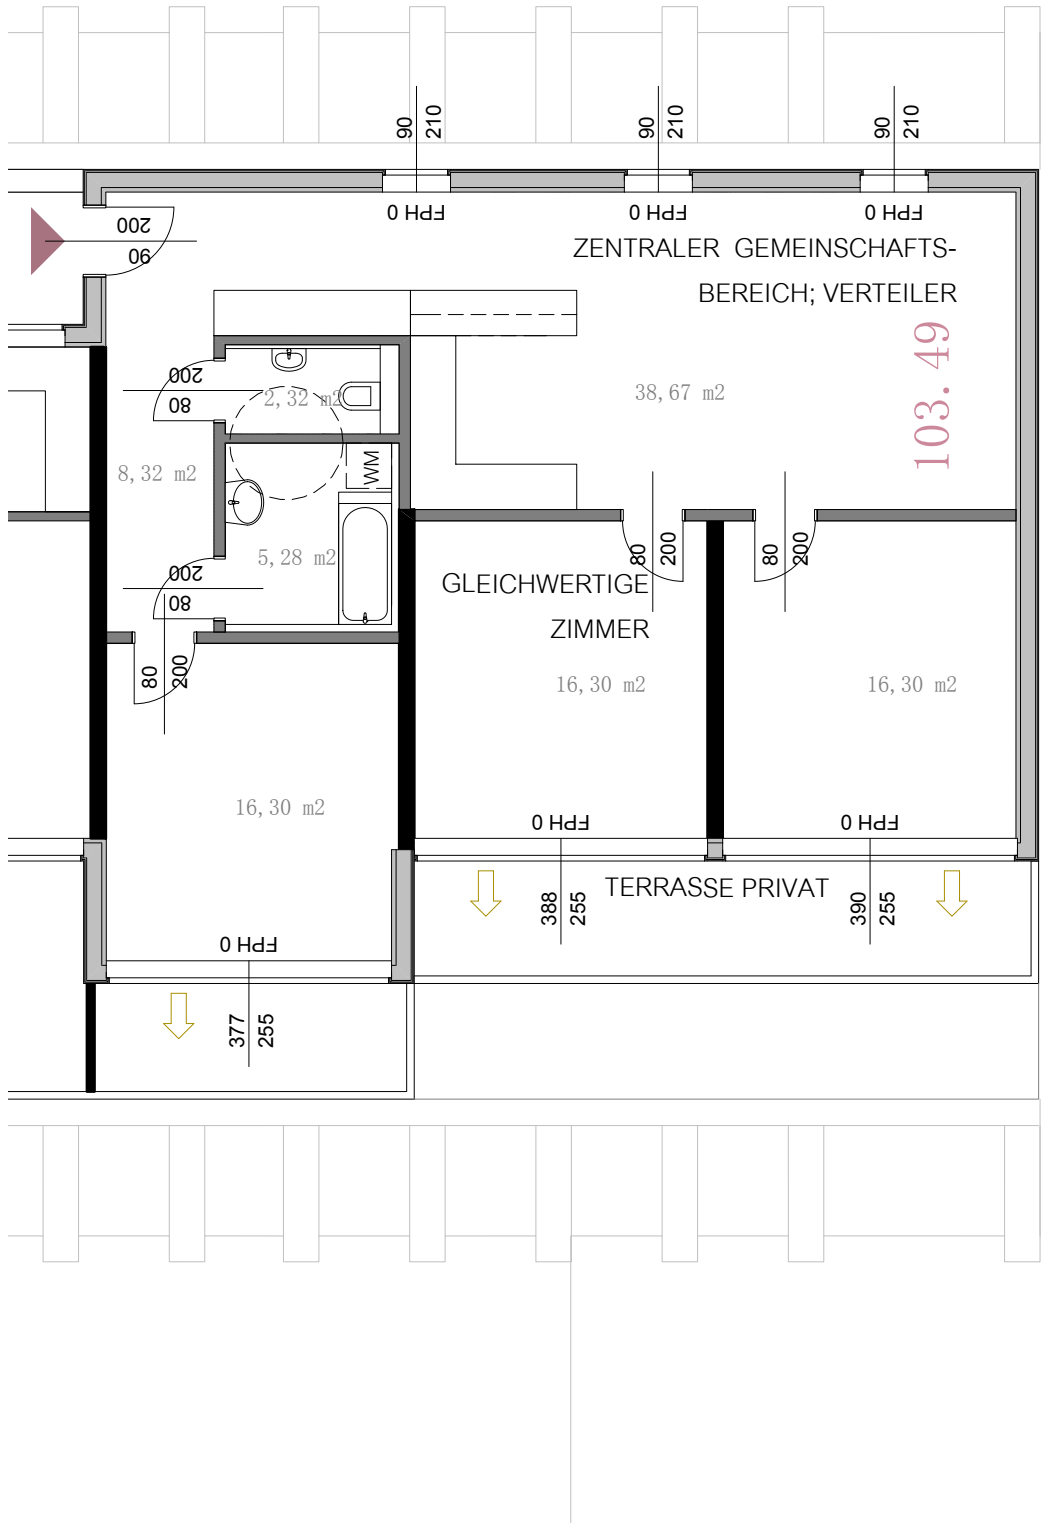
Ausschnitt Grundriss 3. Obergeschoss
